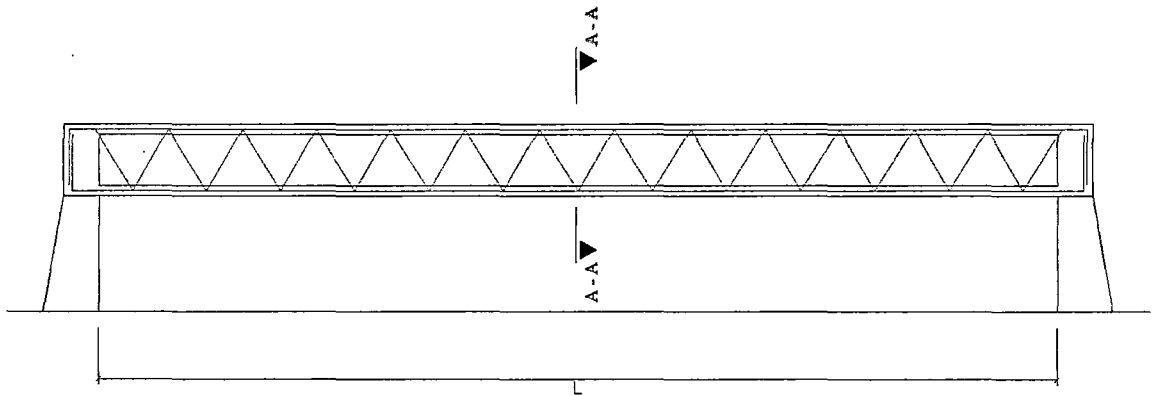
Vista en Elevación Típica de un Puente que emplea Tridilosa
